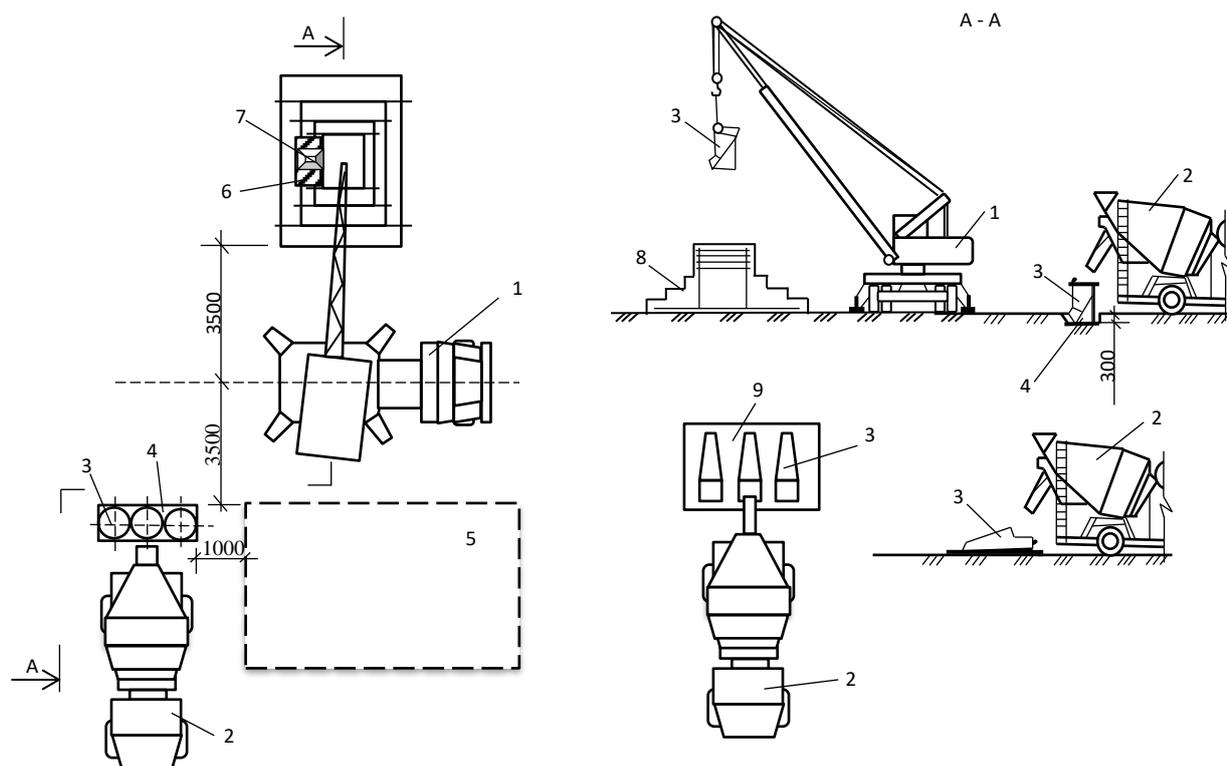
Схема организации работ при подаче бетонной смеси краном в бадьях:
